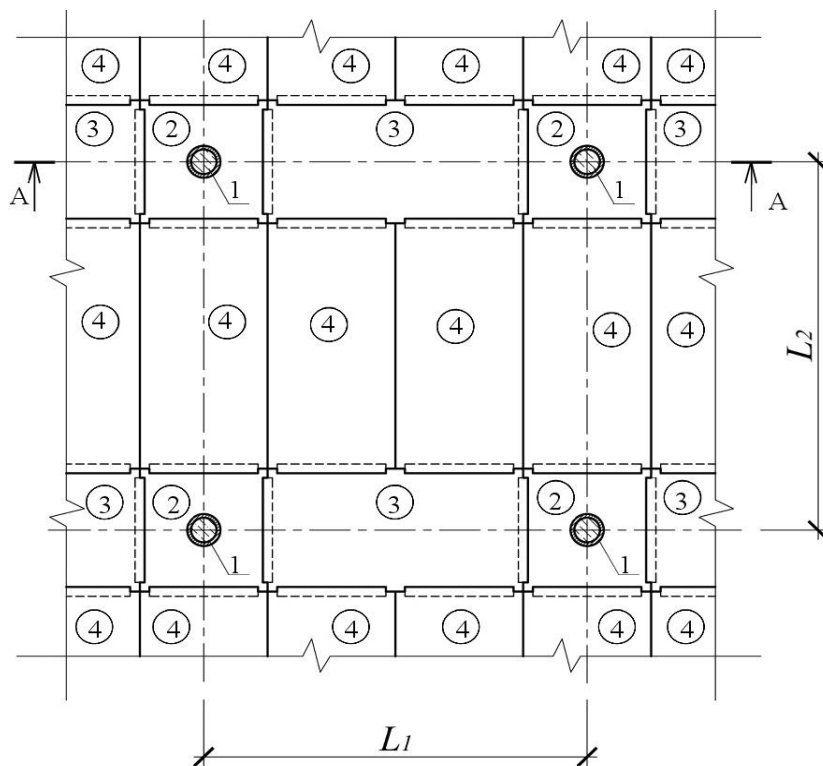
Фрагмент збірного сталезалізобетонного безбалкового перекриття:
